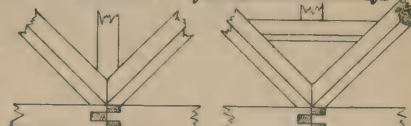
Gratsparren-Verbindungen im Anfallpunkt bei Walmdächern. Grundriss-Darstellung.
